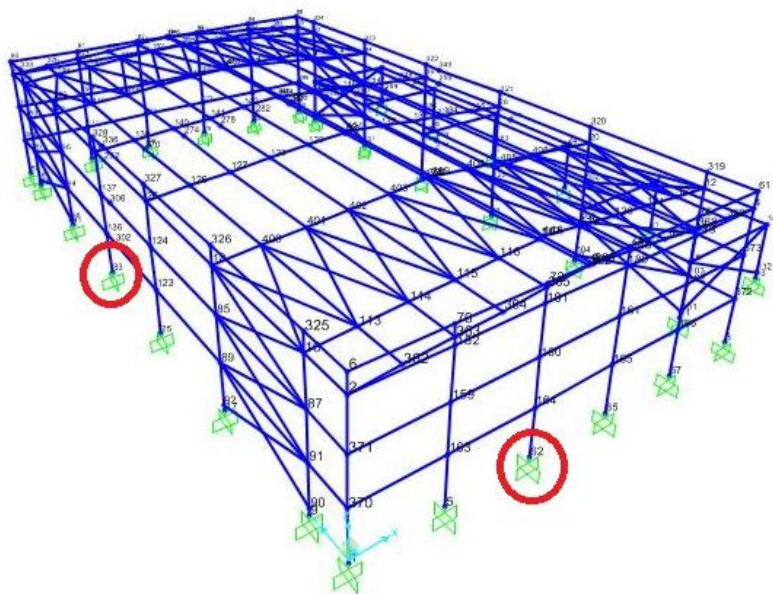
Situación de soportes para cálculo de las zapatas del pilar izquierdo y del muro piñón
